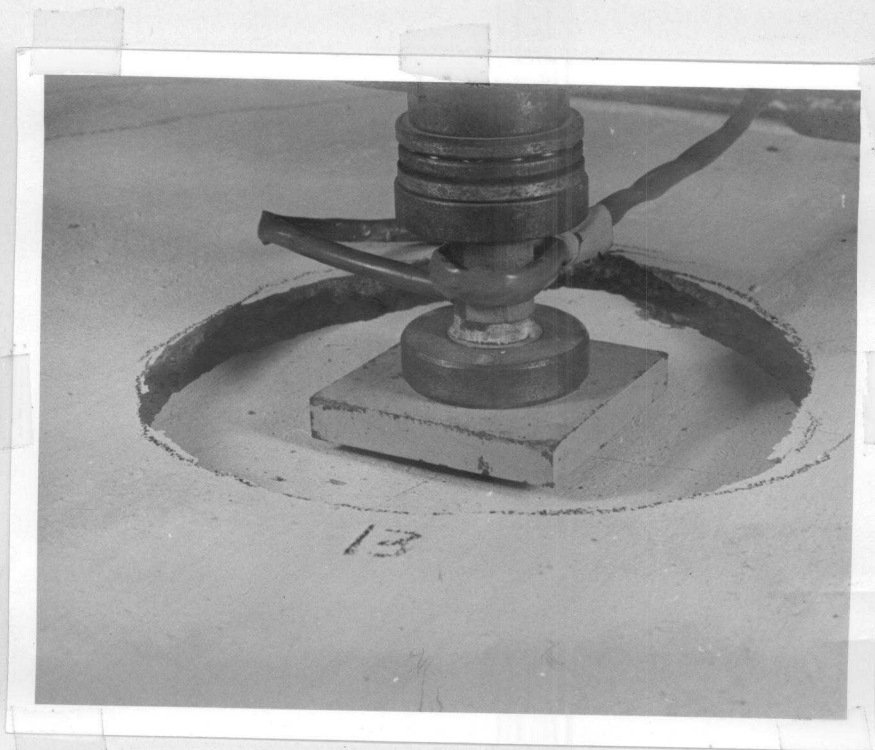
Detalhe da face superior de uma laje na ruptura.
